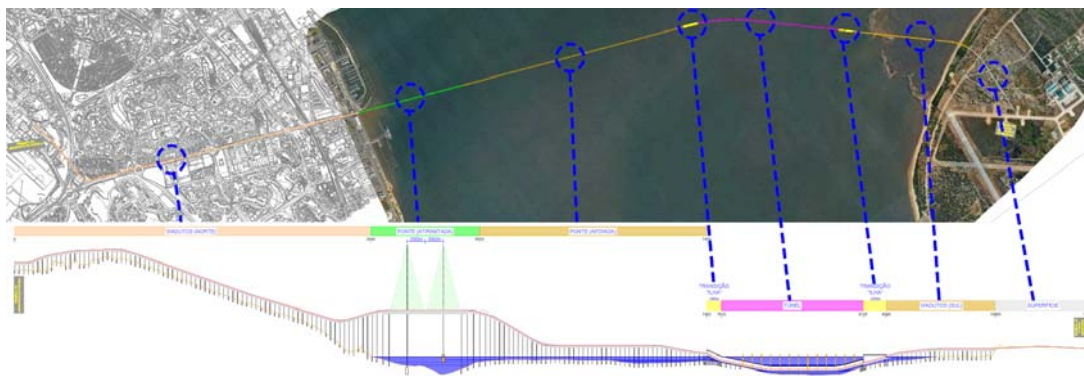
Solução proposta para a infraestrutura (Planta e Perfil Longitudinal)
